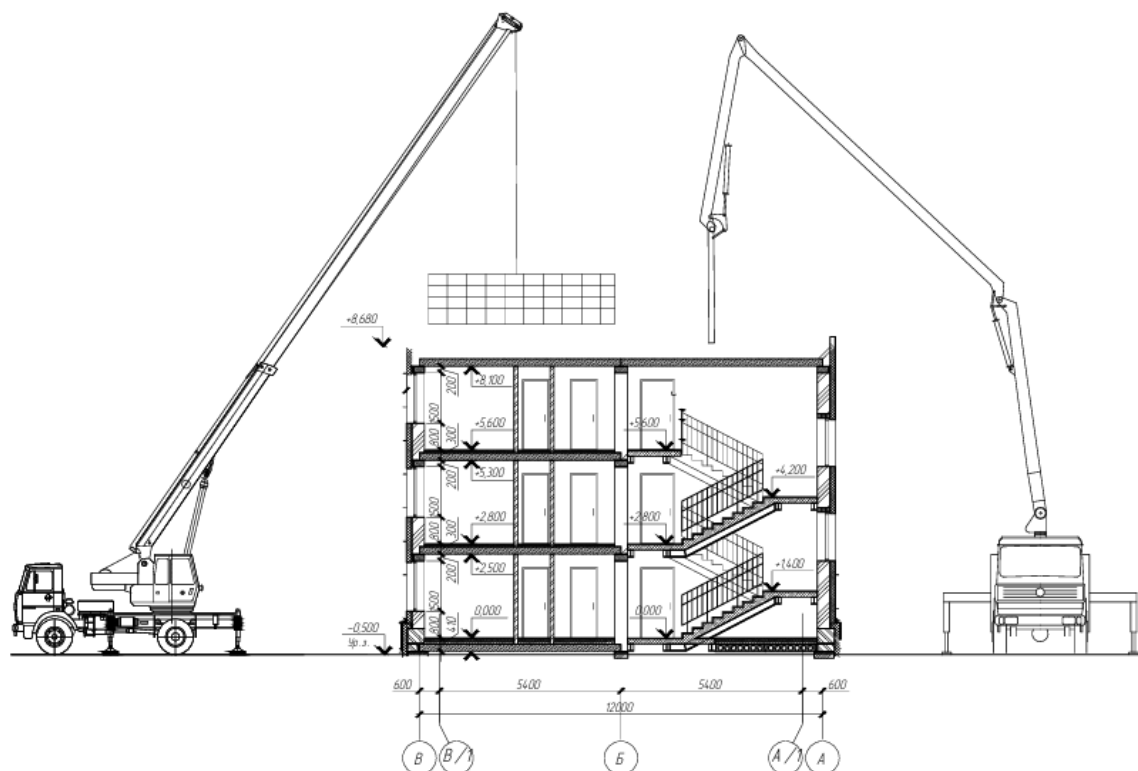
Схема укладки бетонной смеси и подачи пакета с арматурой
